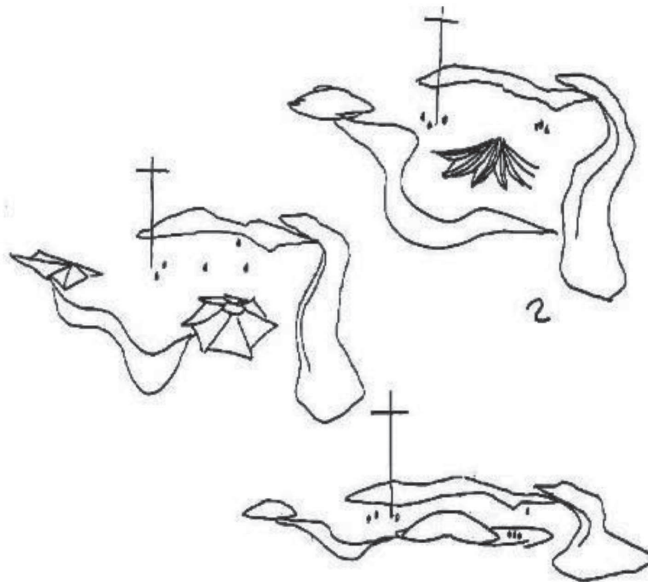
Oscar Niemeyer, croquis para el convento de los dominicanos en Saint Baume, Archivo Fundação Niemeyer
